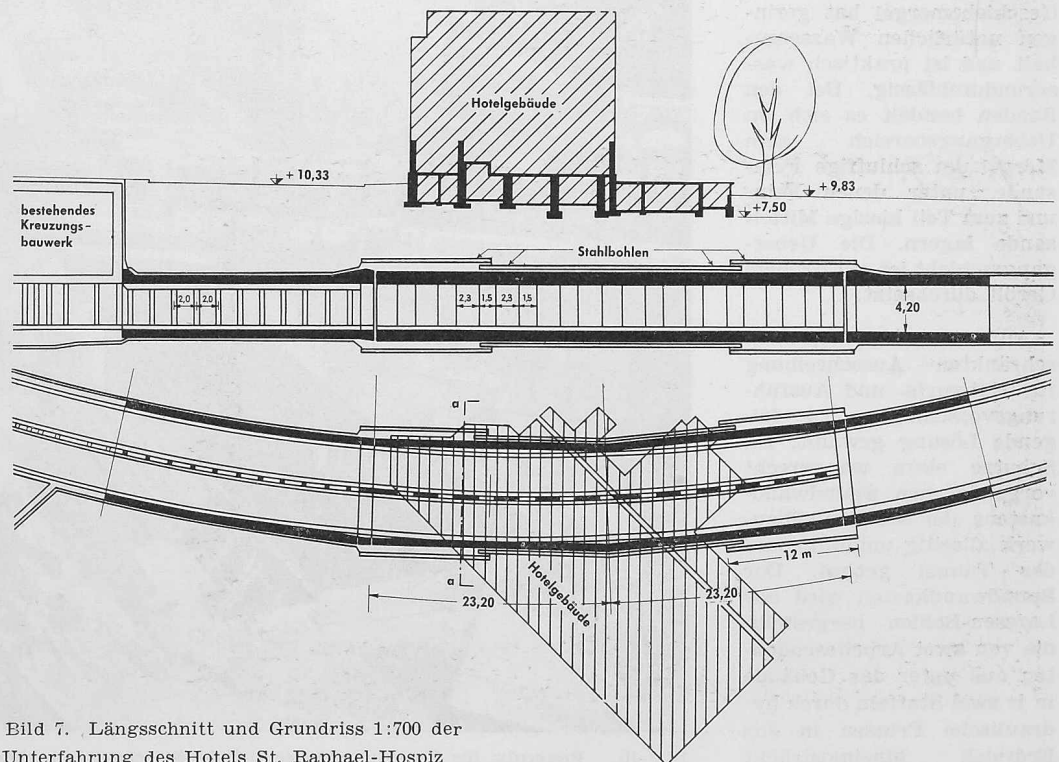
Längsschnitt und Grundriss 1:700 der Unterfahrung des Hotels St. Raphael-Hospiz
